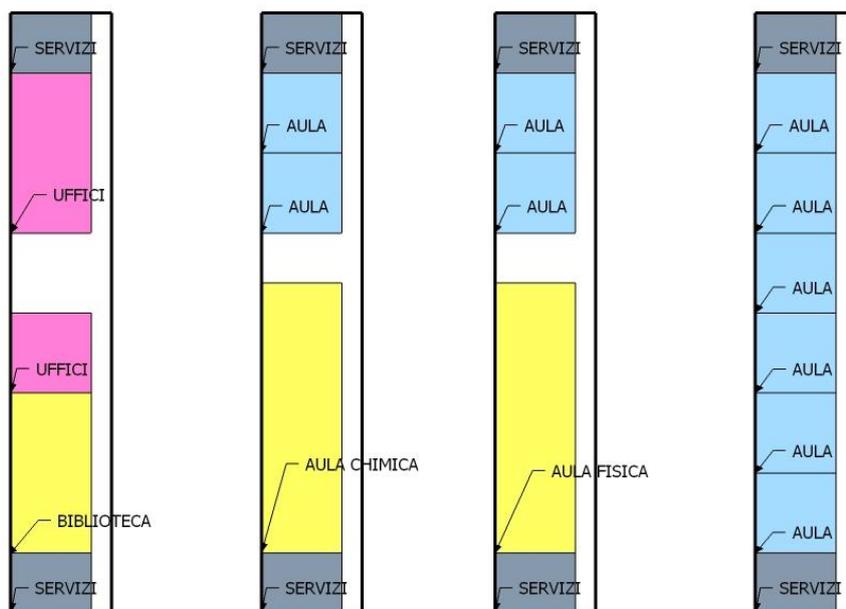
Schemi architettonici e distribuzione planimetrica dell'edificio archetipo
